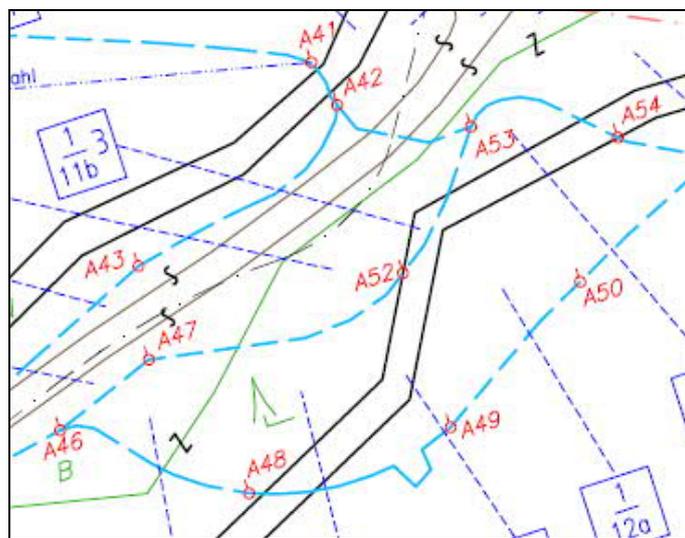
Ausschnitt eines Absteckplanes von Grundeinlösepunkten
